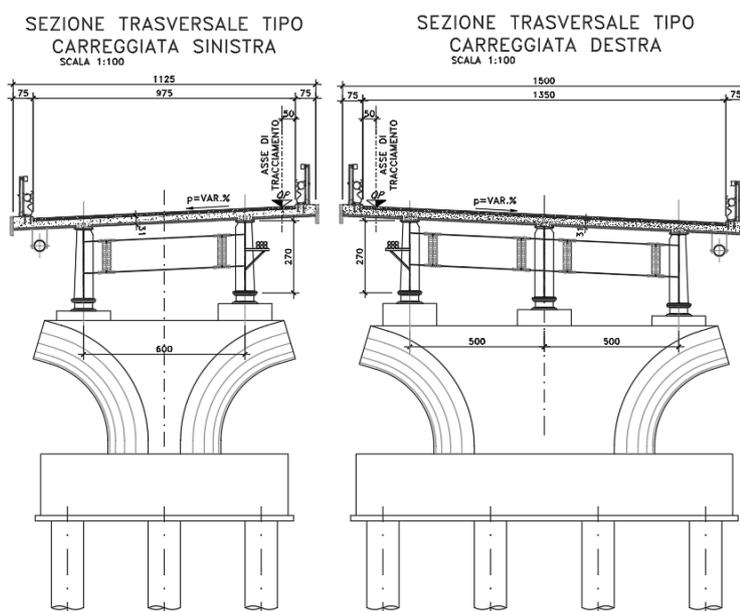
Sezioni trasversali impalcato due travi e tre travi
